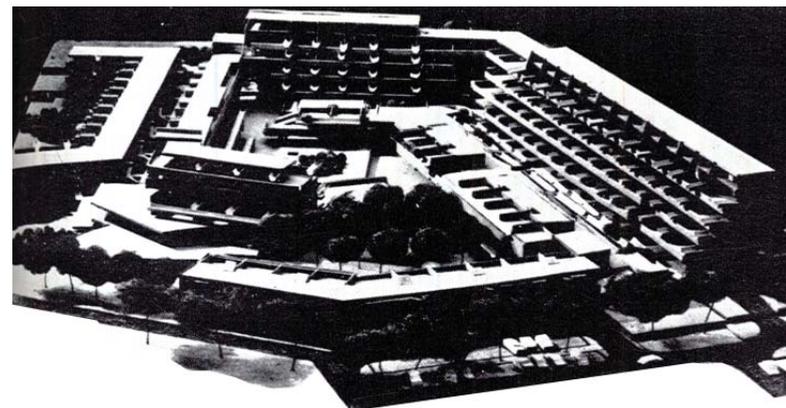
Imagen de la maqueta de un hotel en el plan de Vilamoura. Solución de sección escalonada para el aprovechamiento de las terrazas y balcones.
